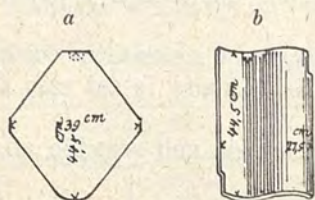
a, b. — Tegole di cemento di Staudach.
